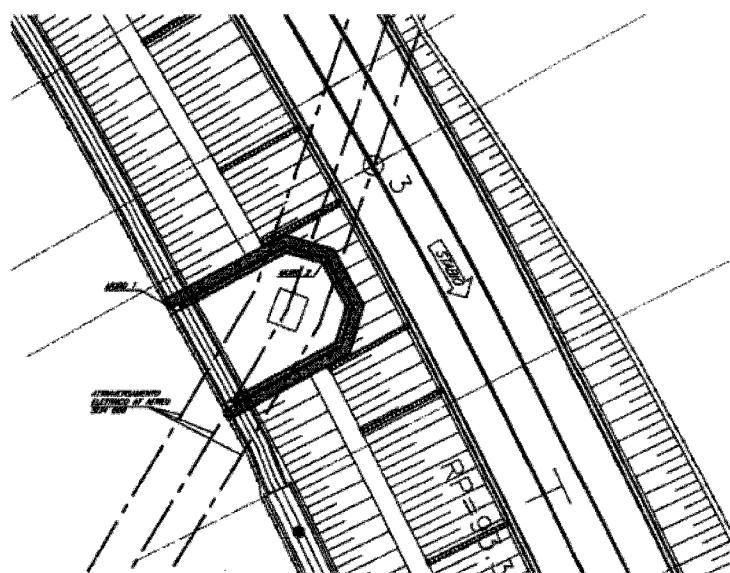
Planimetria della risoluzione dell'interferenza SI34008
